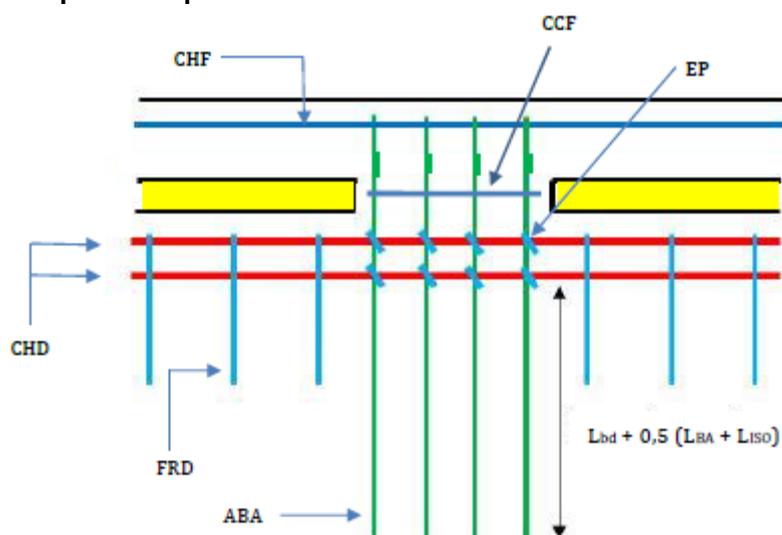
Exemple de dispositions constructives au droit d'un isolant en zone courante
